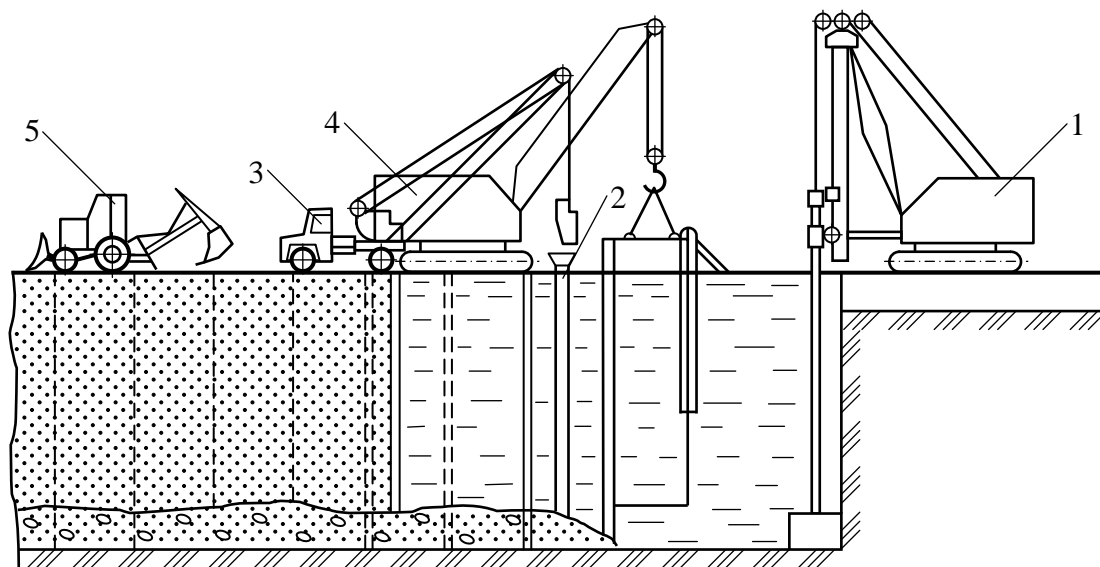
Технологічна схема влаштування “стіни в ґрунті”: 1 – штанговий екскаватор; 2 – бетонна труба; 3 – автокран для укладання бетону; 4 – кран для монтажу панелей; 5 – механізм для зворотного засипання
